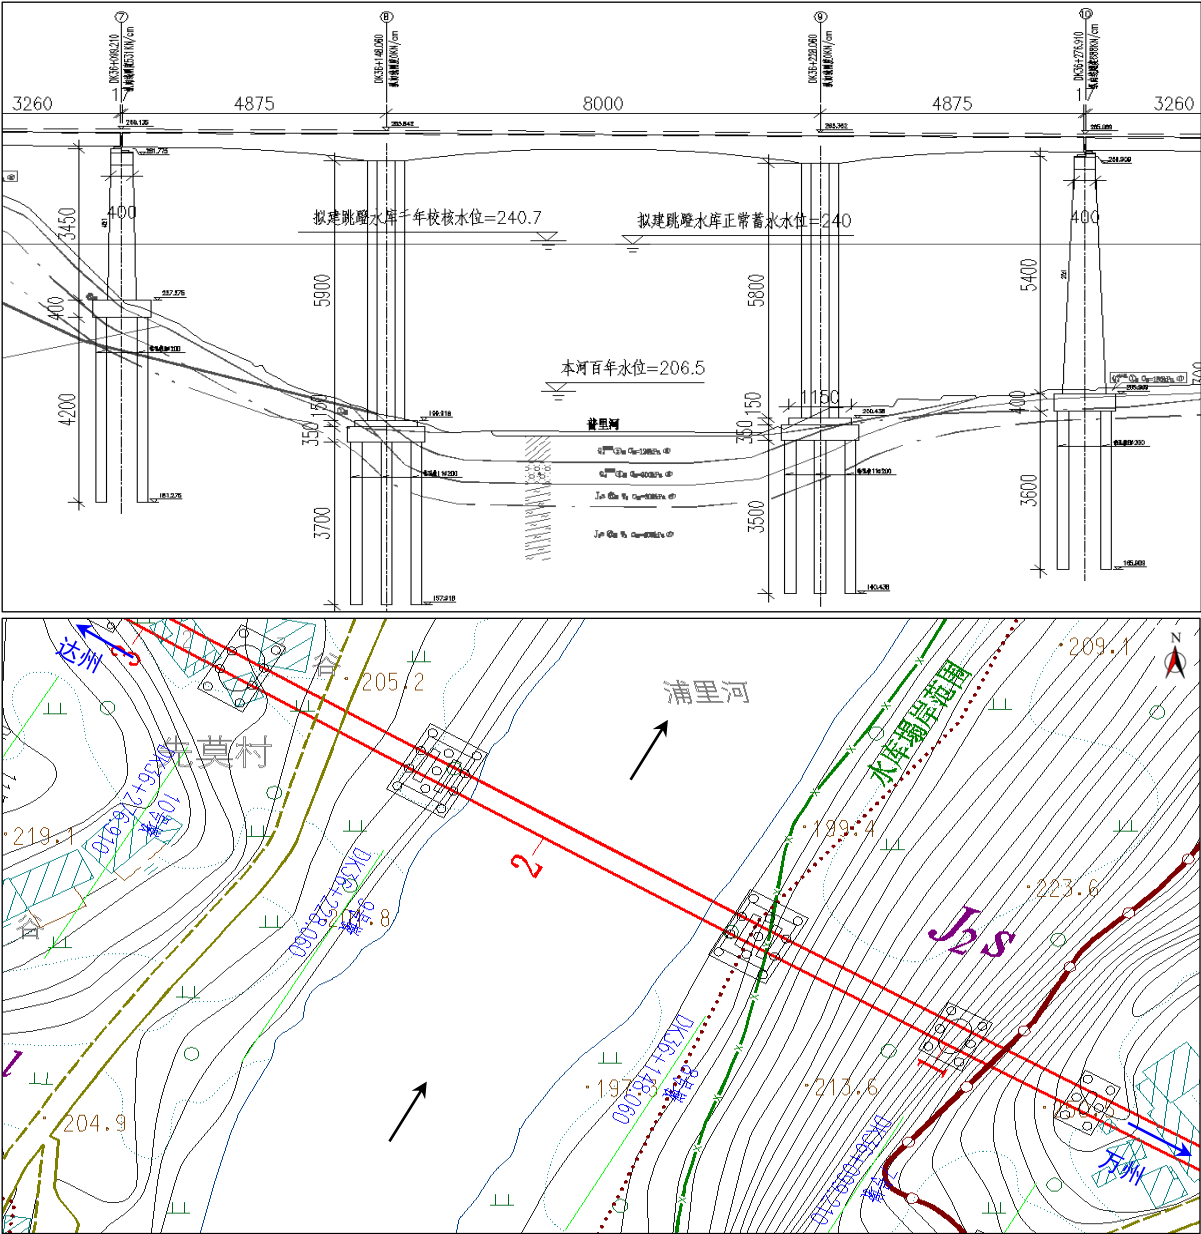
普里河特大桥桥台立面、平面布置示意图
